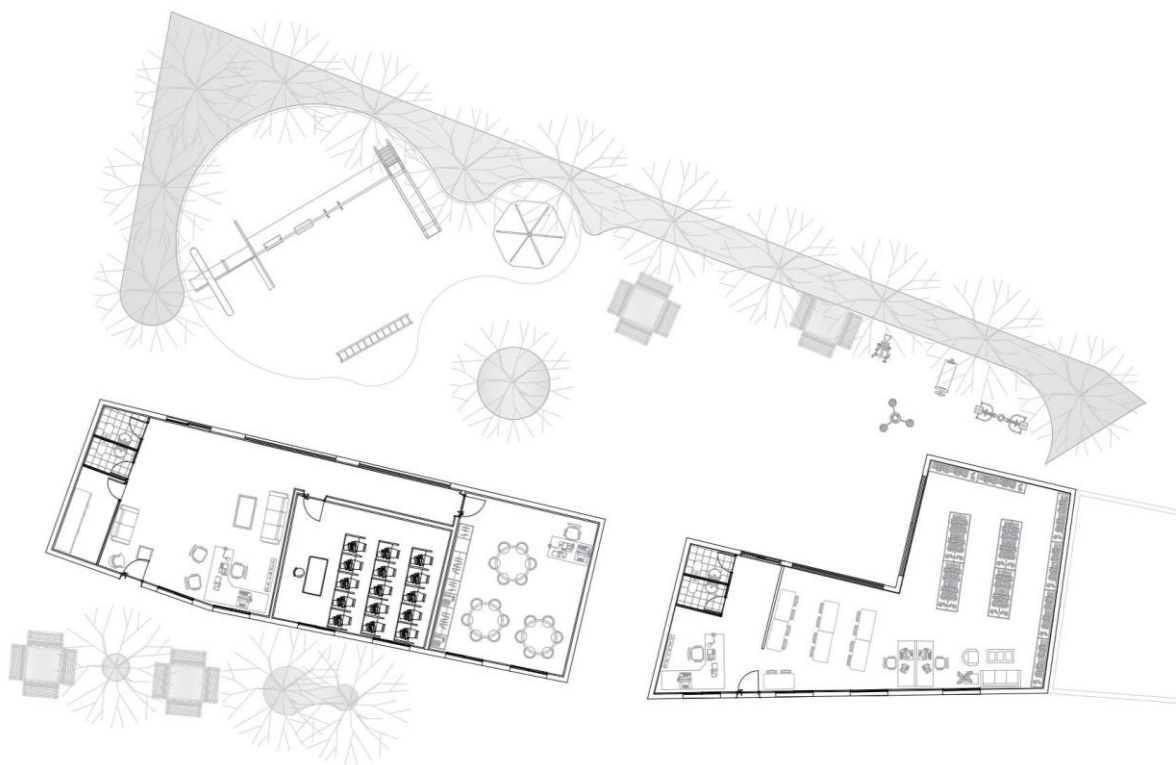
Plantas de Creche, Biblioteca, Parque Infantil, Zona de Lazer
